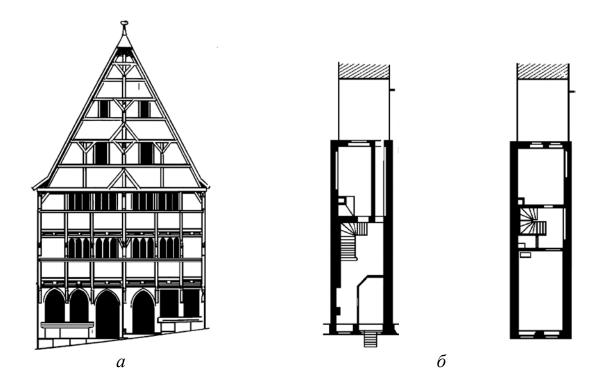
Типы фахверковых домов: a – дом в Марбурге (1320). Фасад;  $\delta$  – дом в Бреслау. Планы 1-го и 2-го этажей
